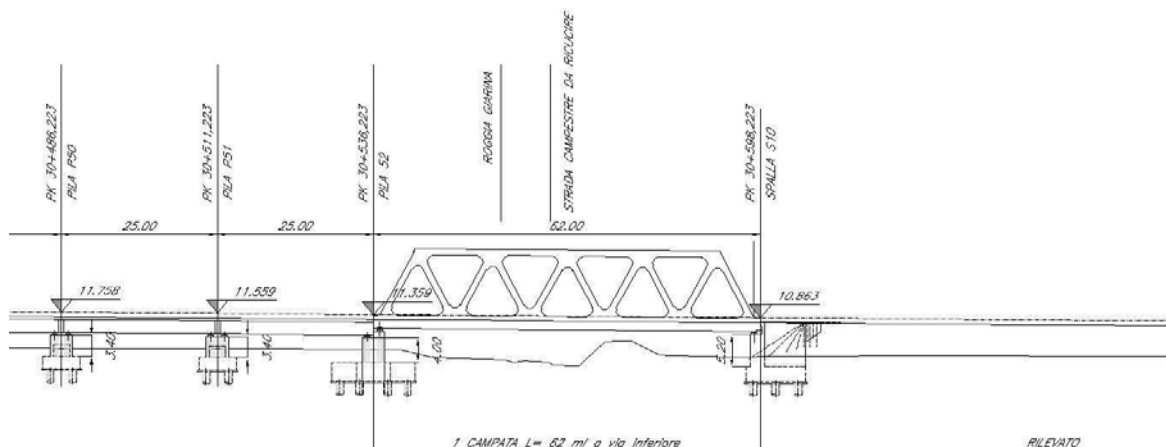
Pianta fondazioni dello scavalco della Interconnessione Palmanova.
